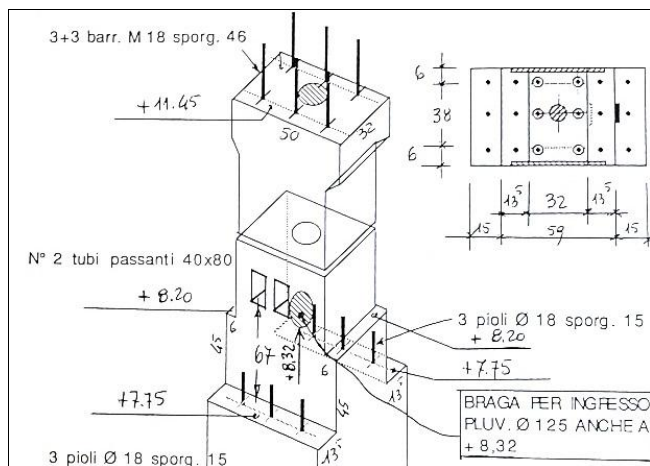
Particolare connessioni pilastro-trave - lotto 4.
